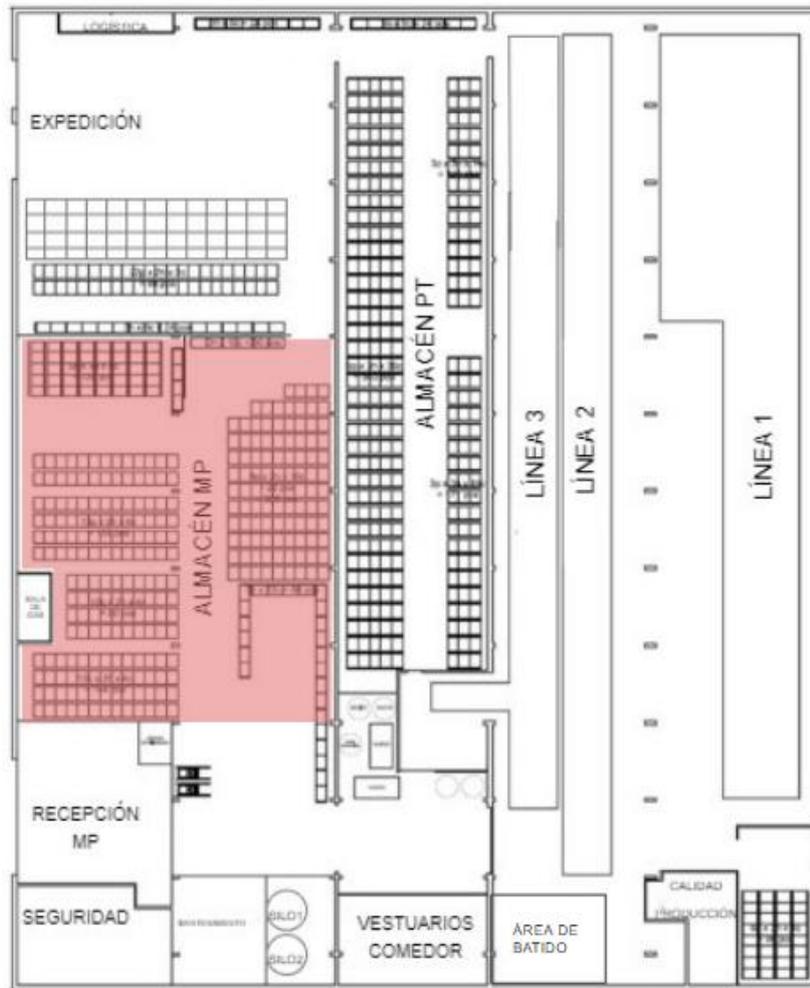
Layout de la planta con área de almacenamiento de MP sombreada en rojo
